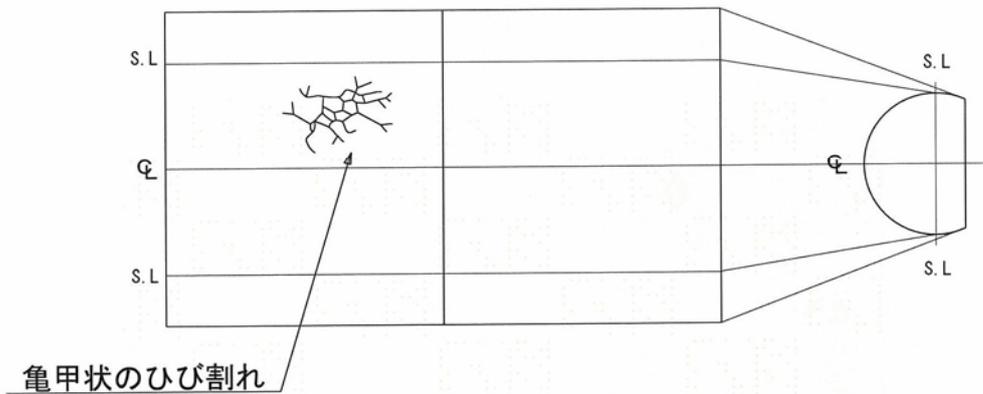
覆工コンクリートの亀甲状のひび割れ
